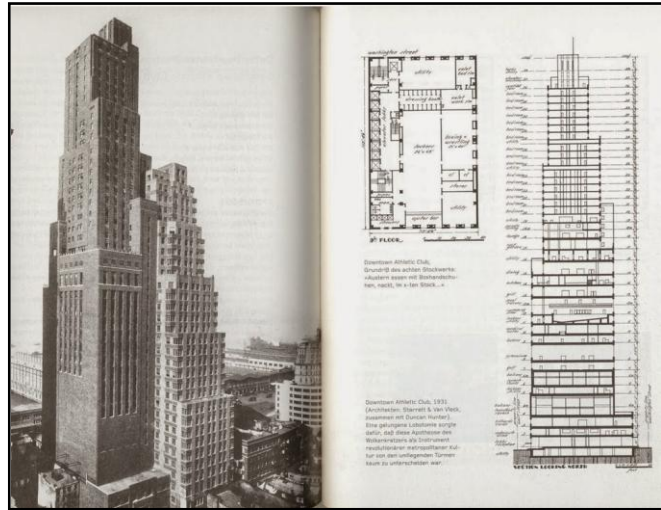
Façades et coupe du Downtown Athletic Club Building - Manhattan, Washington Street -
